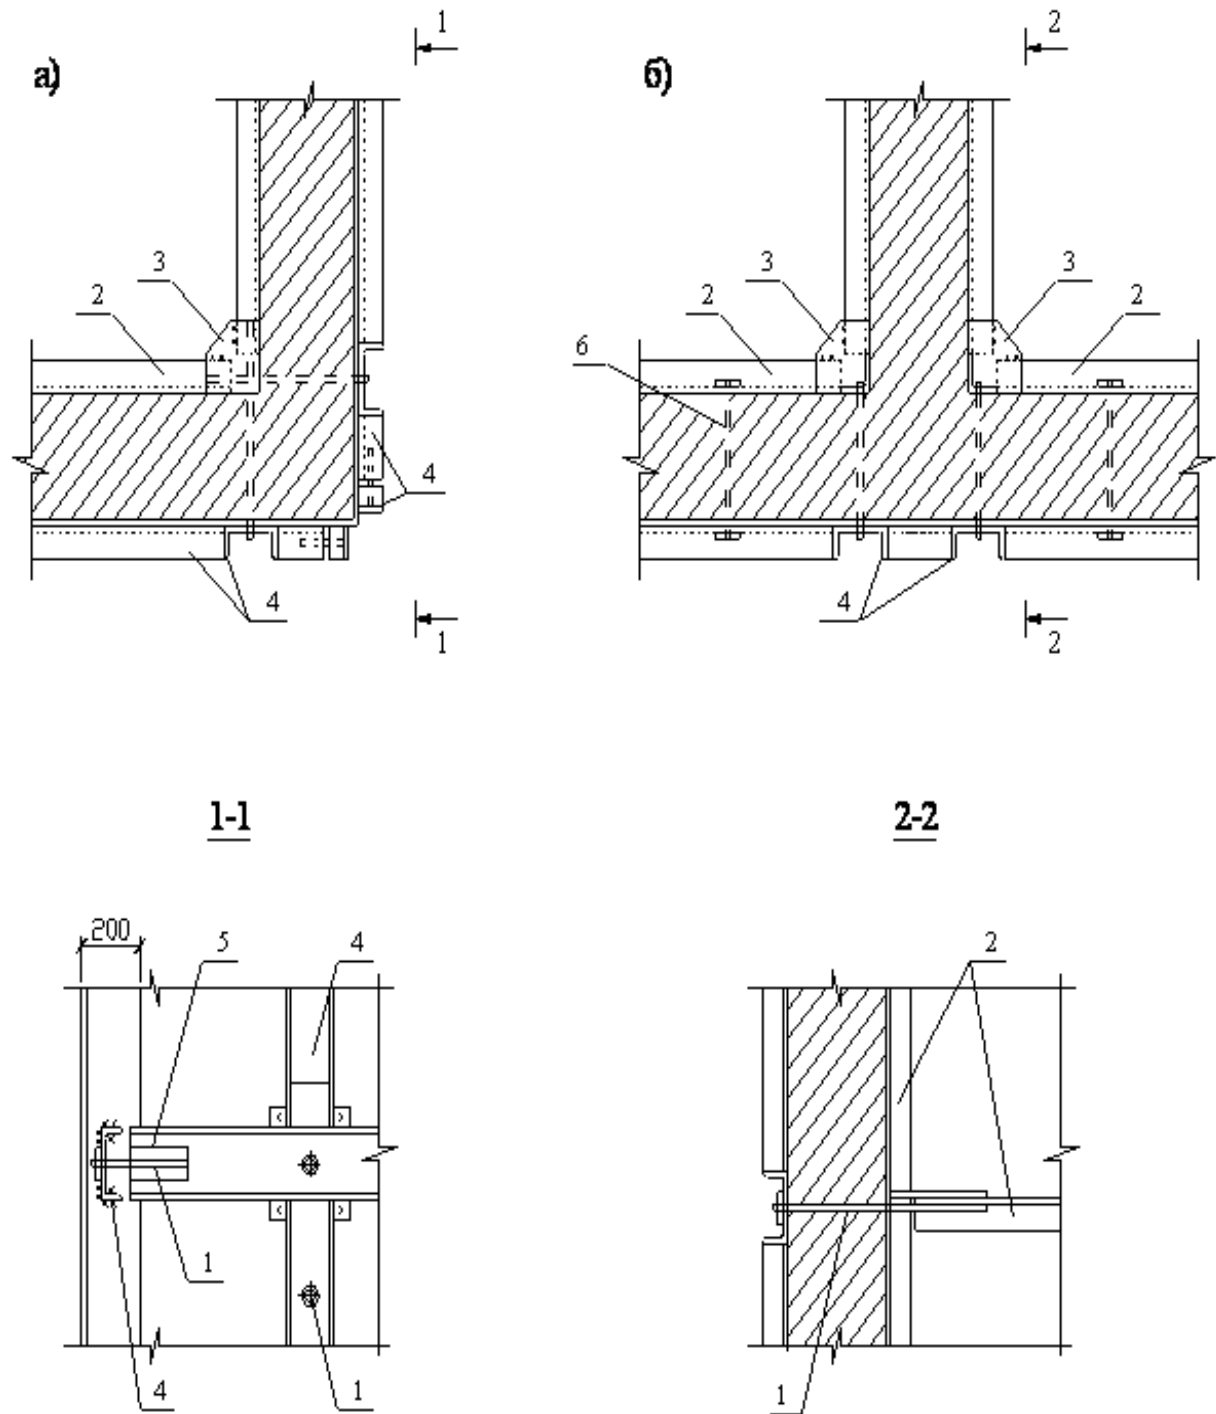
Усиление стен с помощью наружного стального каркаса
